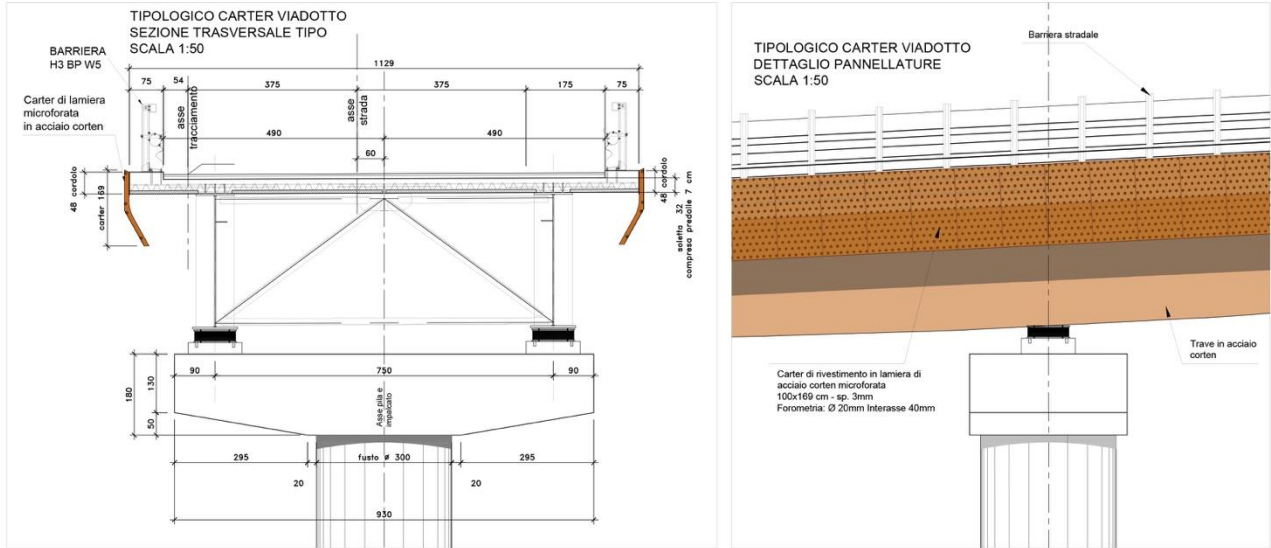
Sezione trasversale e longitudinale tipologiche dei viadotti
